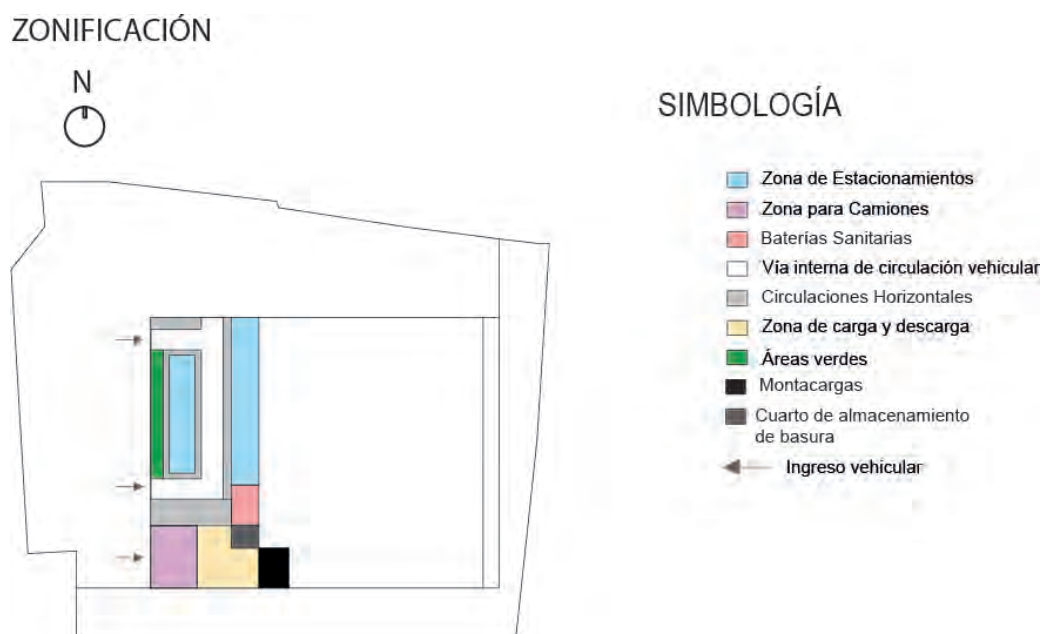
Zonificación Estacionamiento: se aprecia la distribución espacial de las plazas de estacionamientos y espacios; ubicación de accesos, recorridos y circulaciones. Elaboración: El Autor.
